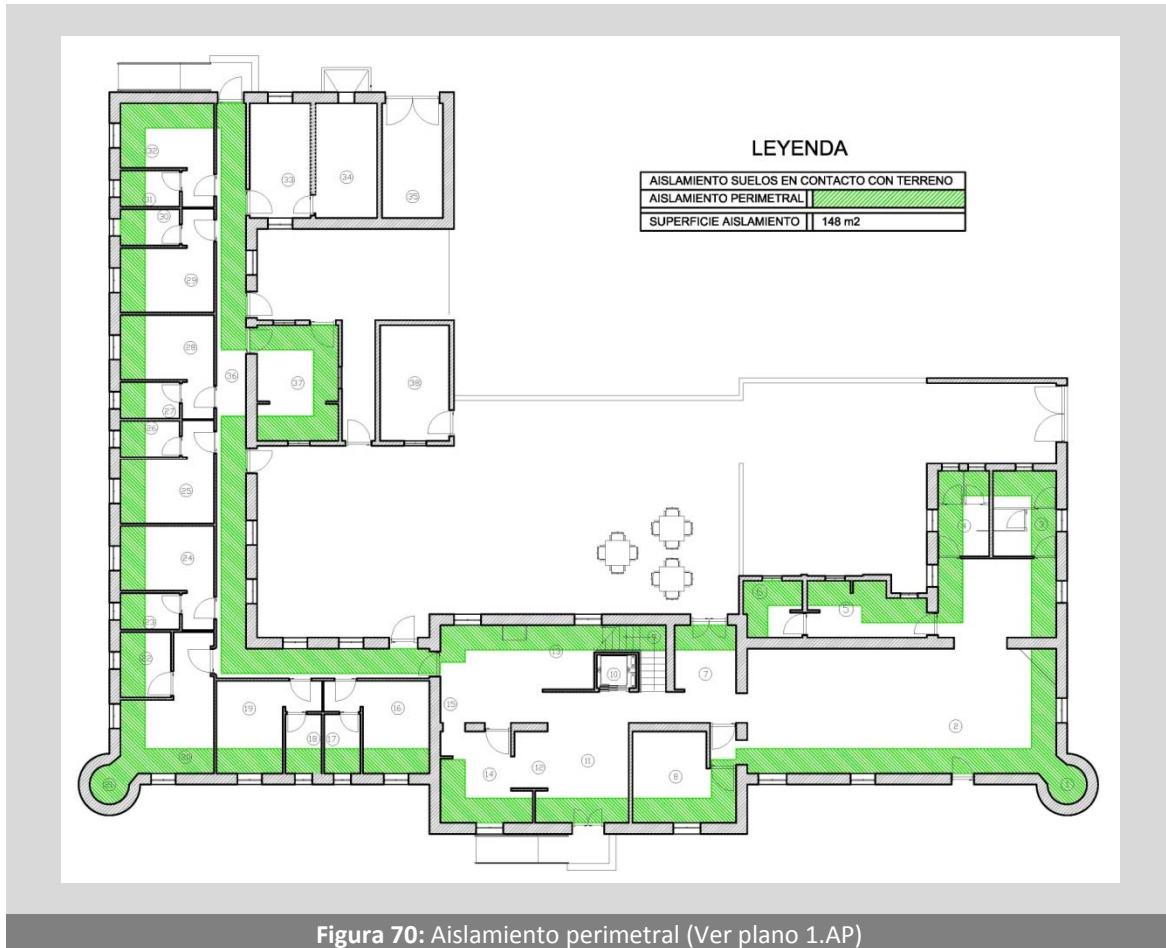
Aislamiento perimetral (Ver plano 1.AP)
